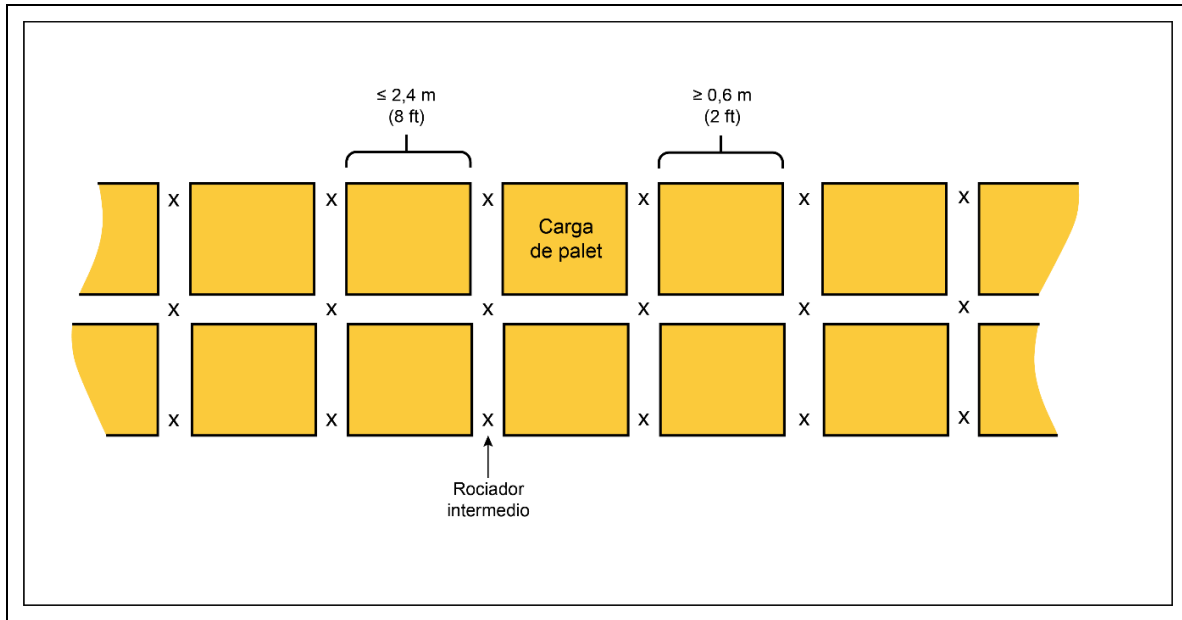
Vista en planta de una configuración horizontal de rociadores intermedios en cada chimenea transversal para estanterías dobles (frontales y en las chimeneas)
